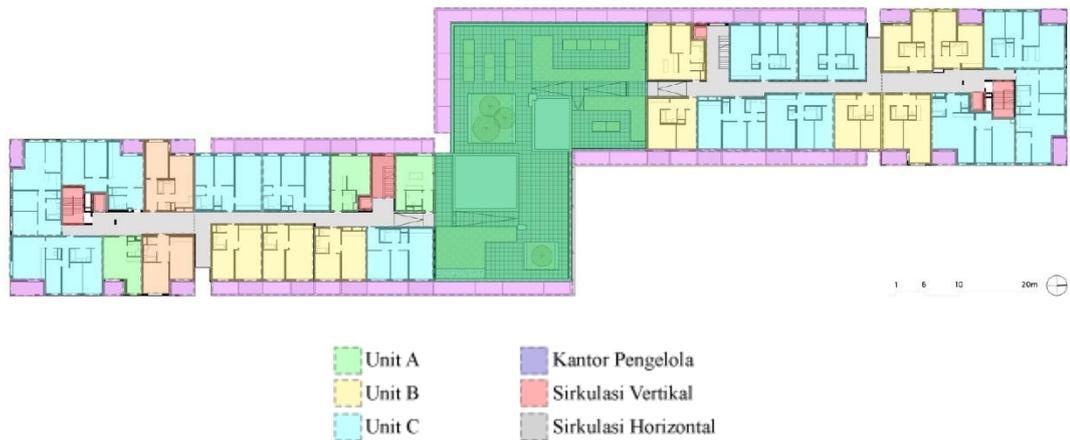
64 Denah lantai 3 *Querbeet Social Housing* (Sumber: Archdaily.com)
